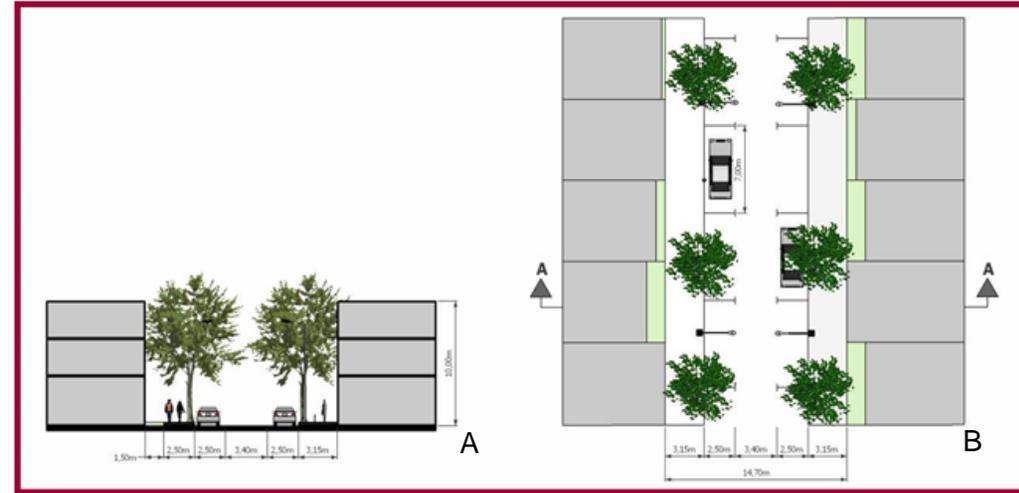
(A) Coupe et (B) plan d'une rue à double sens
